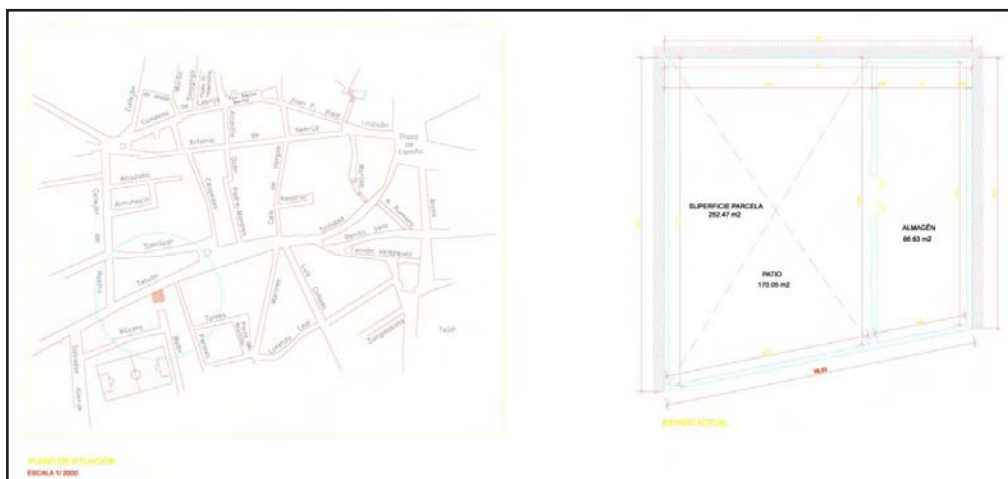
Situación y planta de la parcela nº 41, de la C/ Tetuán de Lebrija. Sevilla.
